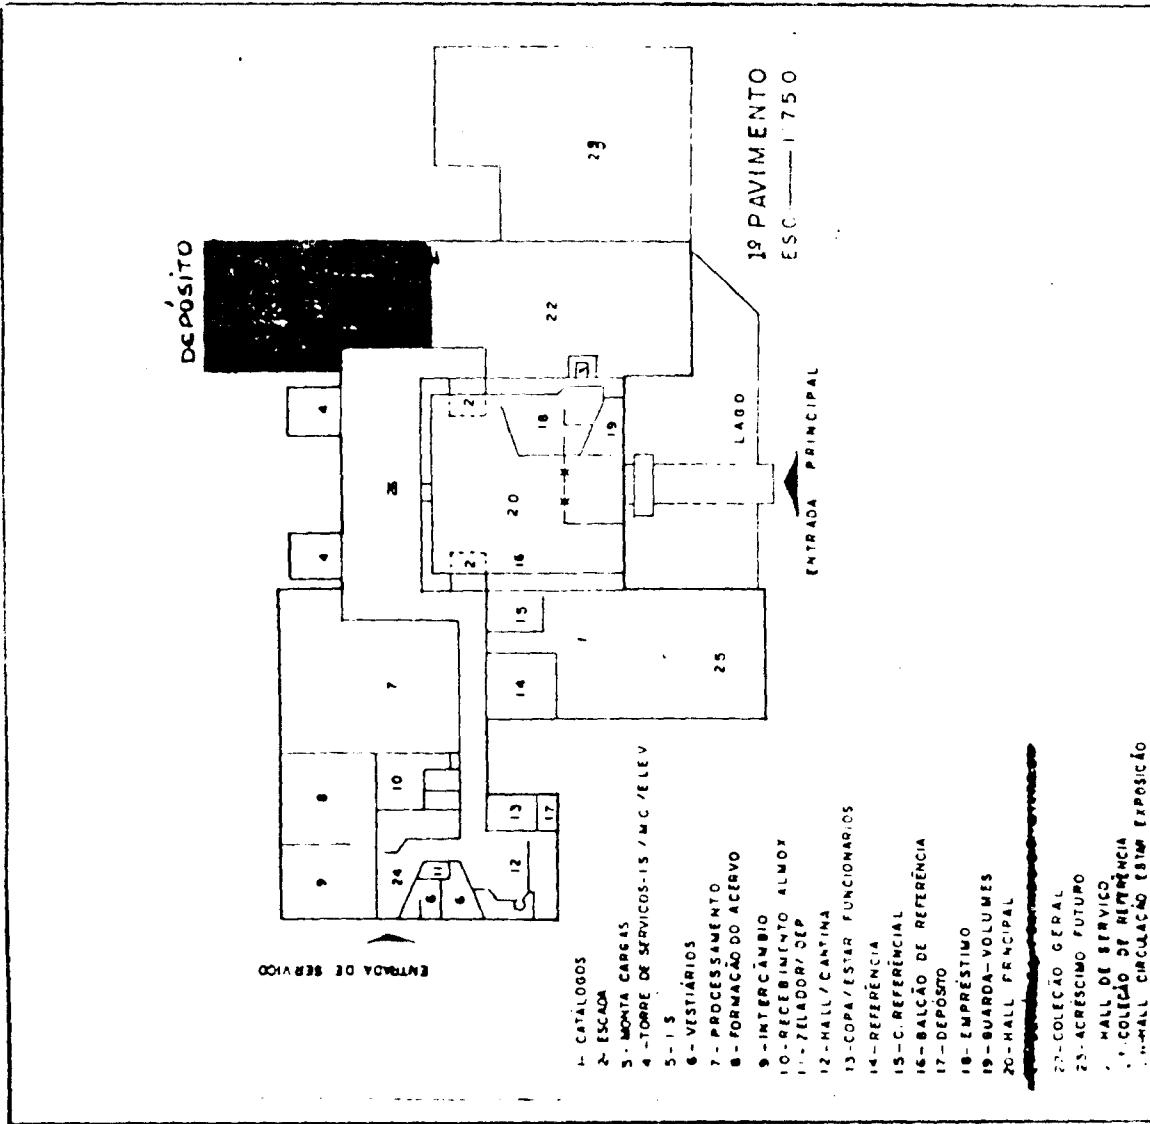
Projeto de construção do prédio da Biblioteca Central - 1º pavimento
